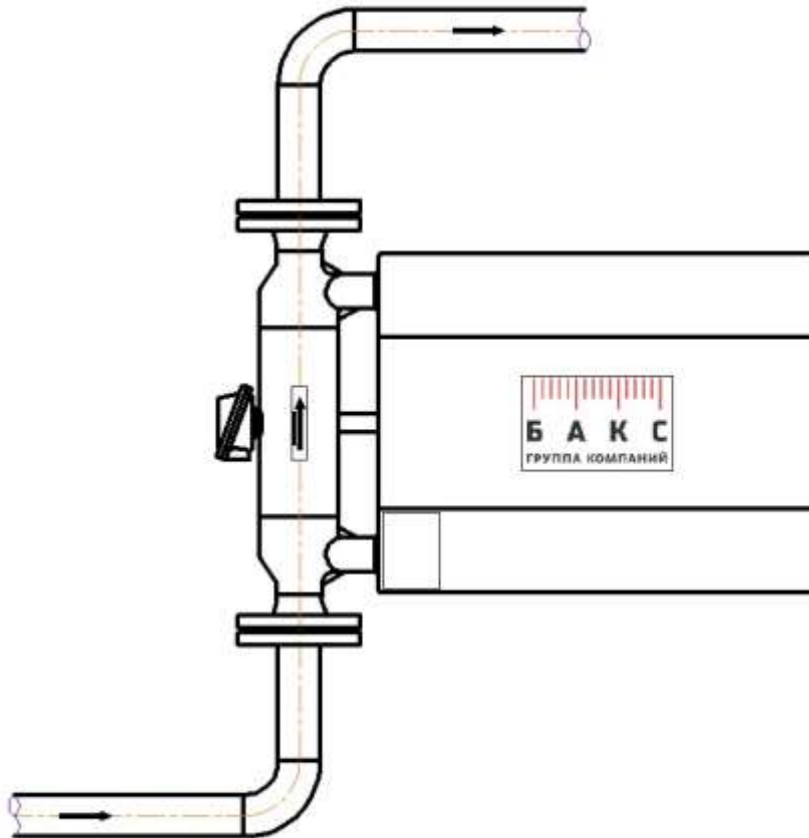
Монтаж расходомера в вертикальный участок трубопровода
